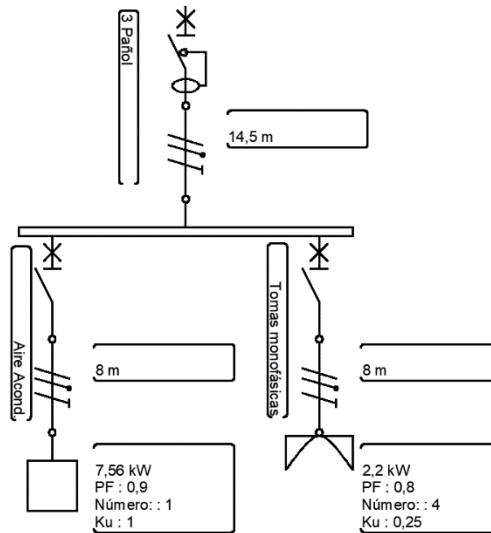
Unifilar Tablero Seccional 3 Pañol
